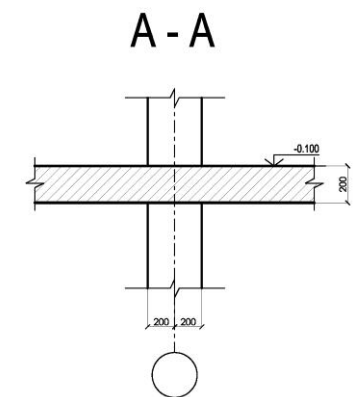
Схема бескапитального стыка колонны и плиты перекрытия – сечение
